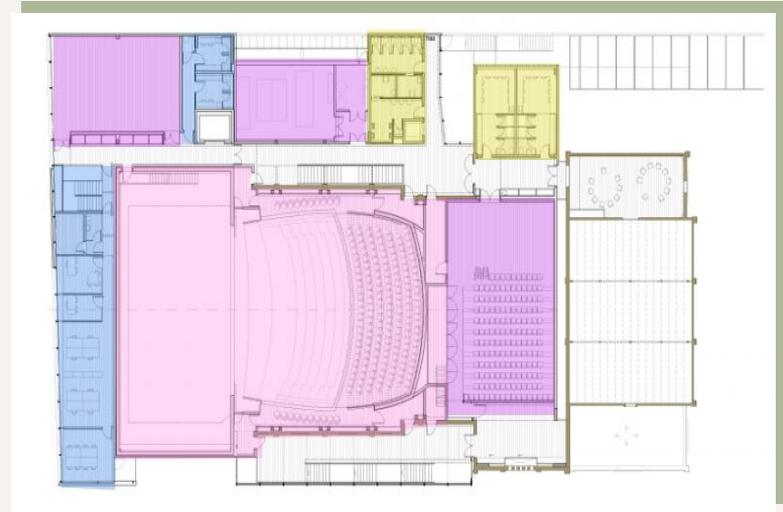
PLANTA 1º PAV. DO TEATRO L'ARTESÁ
